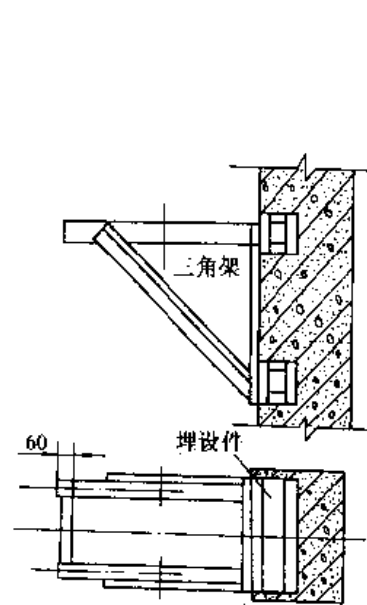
A 式通风机在钢筋混凝土柱上的安装支架
